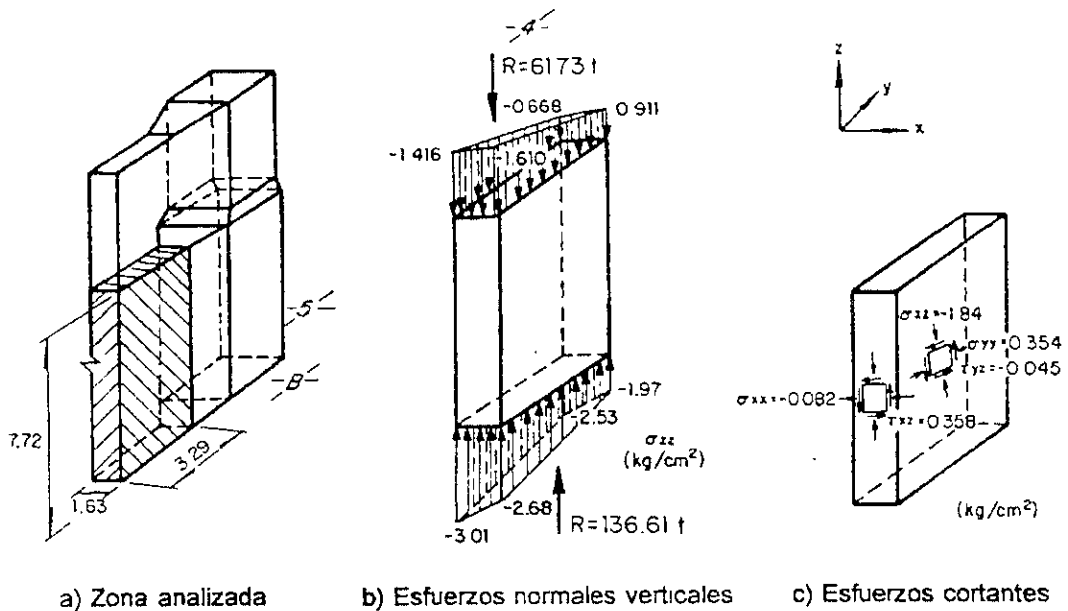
Esfuerzos en el muro de capillas del eje 5 entre A y B.
